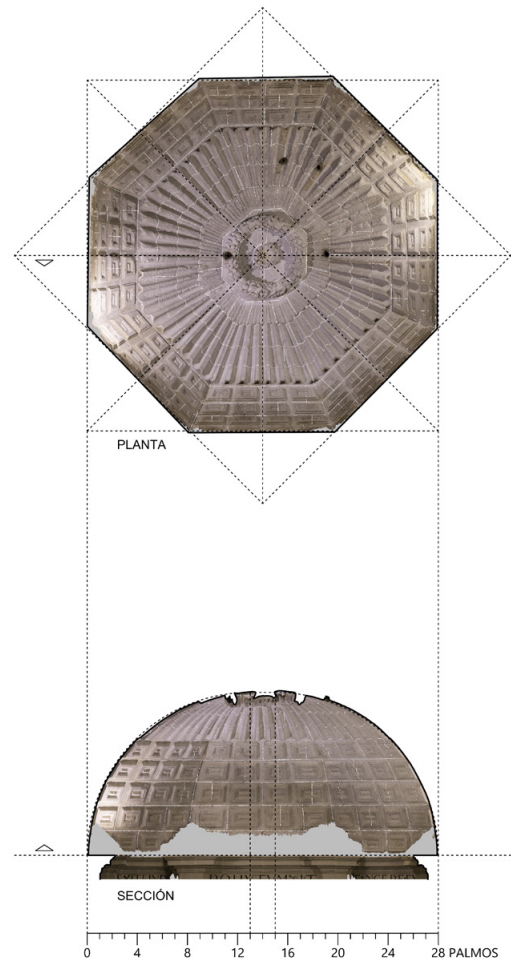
Planta vista desde abajo y sección transversal del ochavo de Jumilla. Fuente: el autor.
